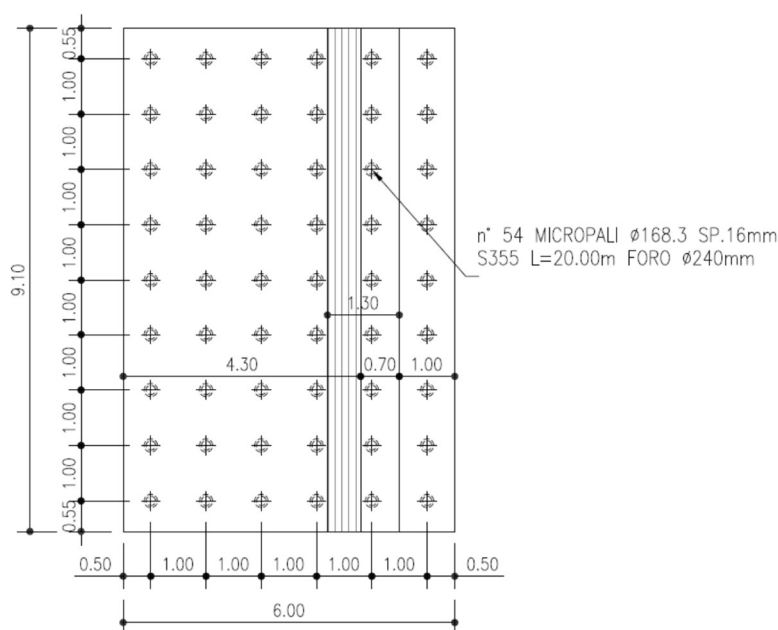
Muri d'ala carreggiata sud – Pianta Fondazioni
